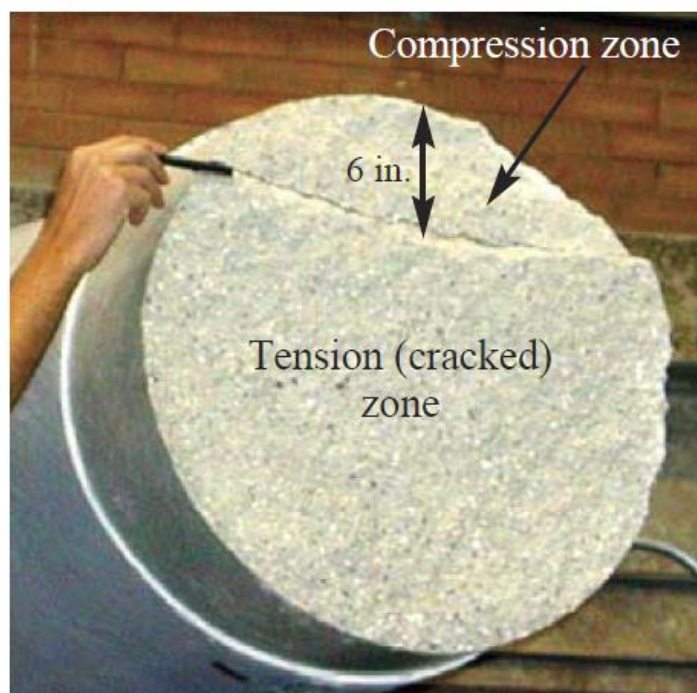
Поперечное сечение бетонного ядра в месте разлома [10]
